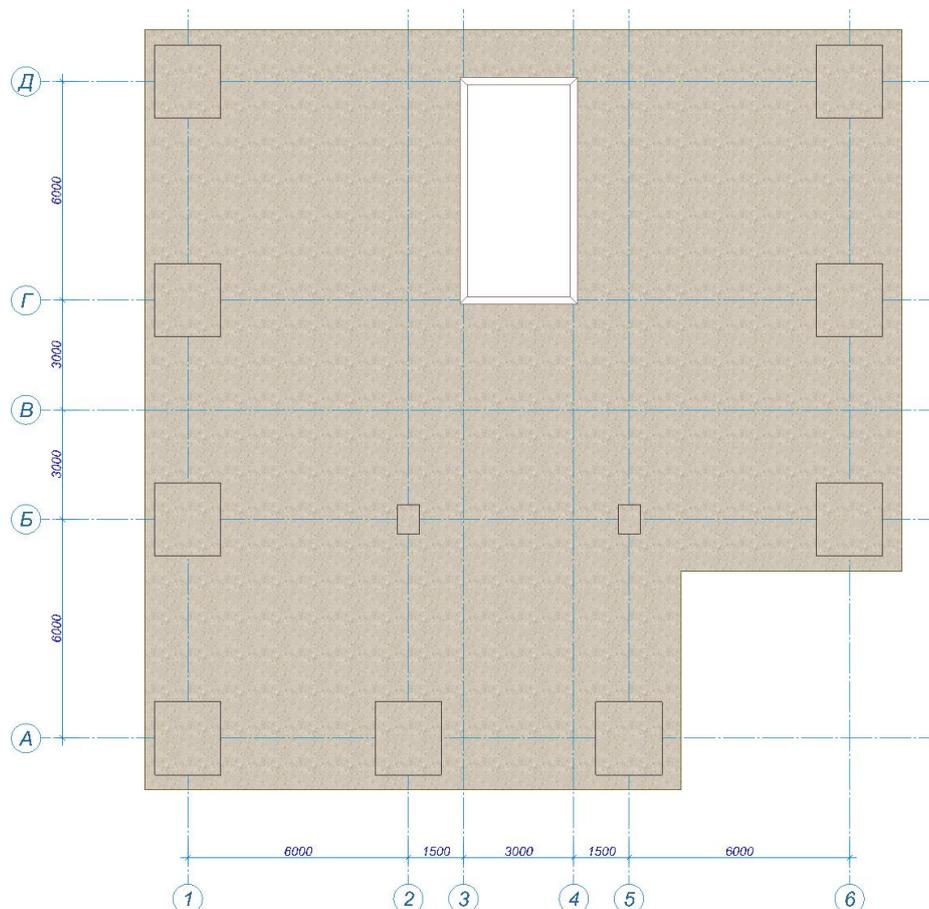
Расположение проема в плите перекрытия на виде сверху
